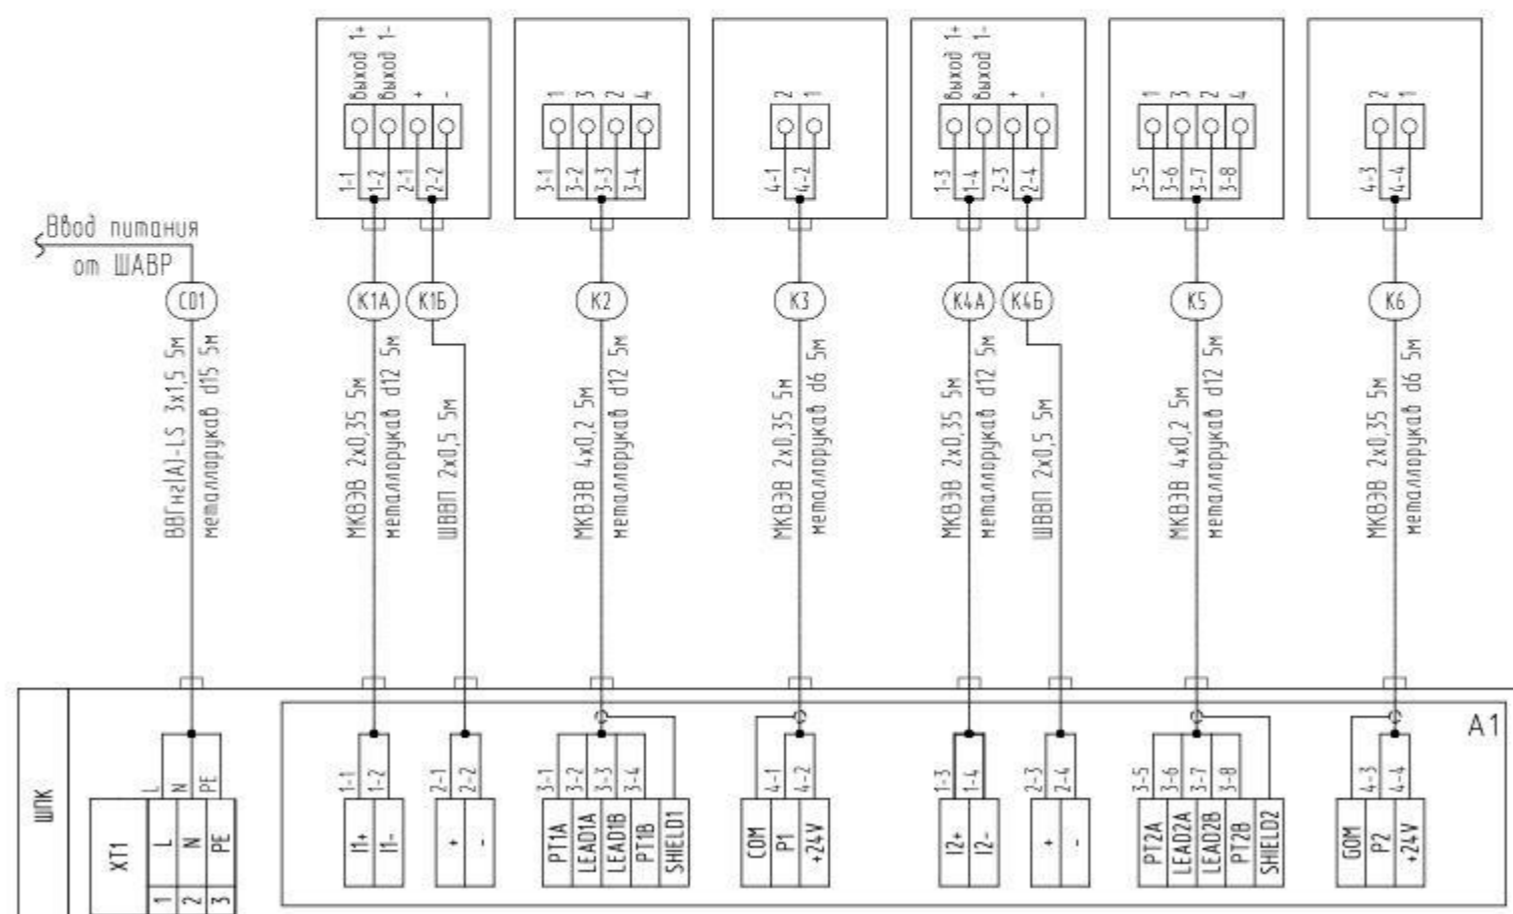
Схема соединений внешних проводов (пример исполнения)
